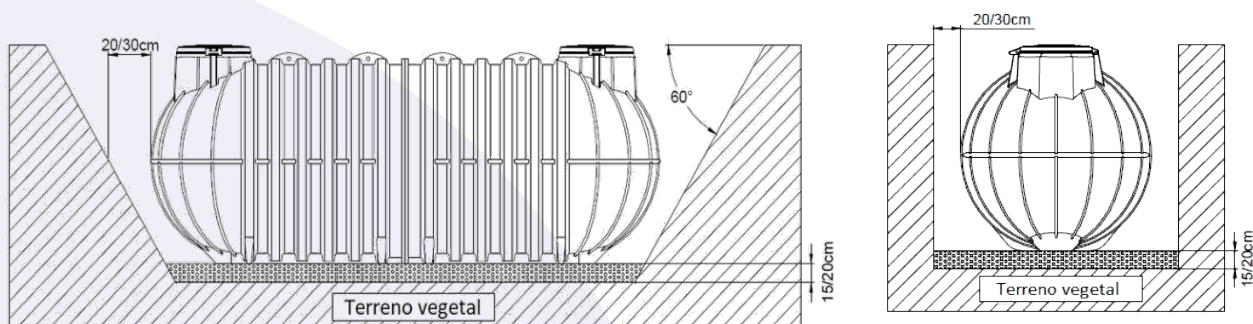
Ilustración I: Perspectiva frontal y perfil de la posición del equipo GEDAR en la excavación.
